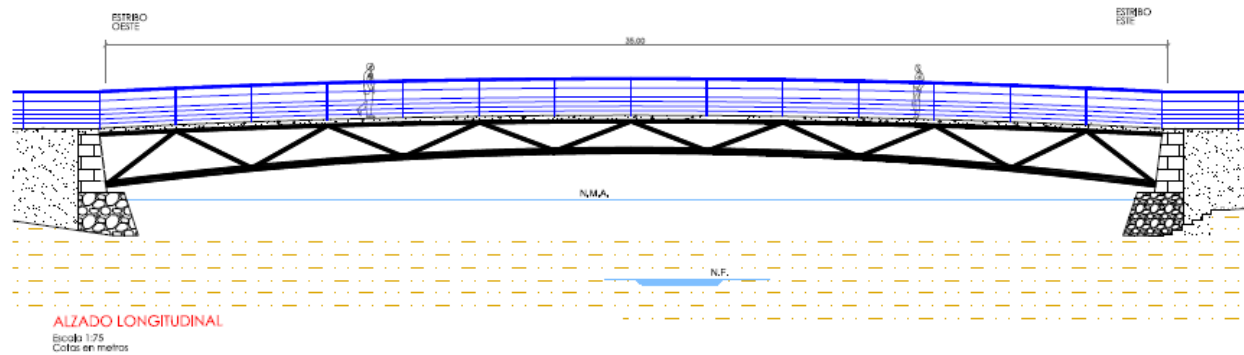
Alzado de la solución tipo viga con celosía inferior
